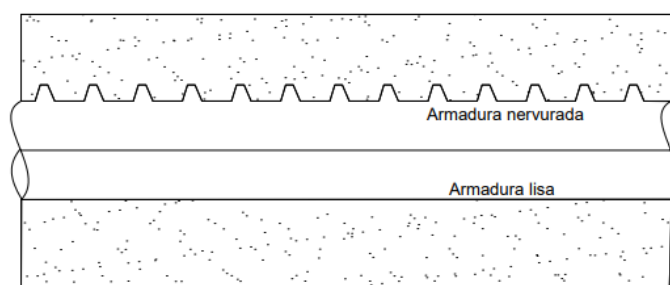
Ligação aço-betão com os dois tipos de armadura.
